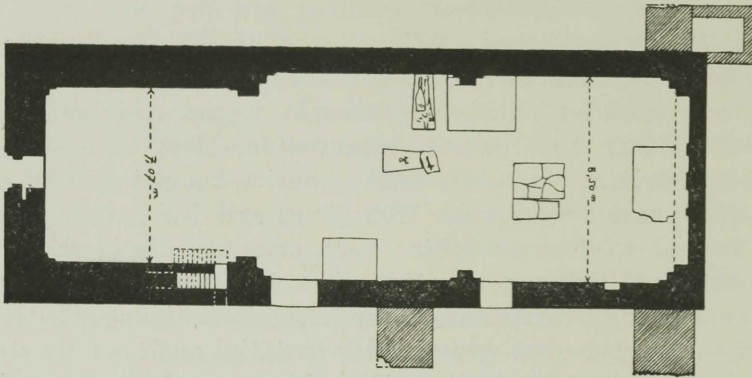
Grundriss der Kirche zu Holme. Nach Neumann.
